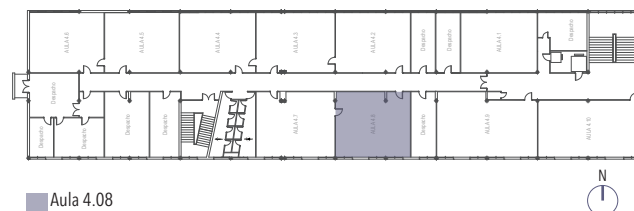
Plano de la planta cuarta de la ETSA - US. Fuente: [www.etsa.us.es/descargas/general/planos/ETSA](http://www.etsa.us.es/descargas/general/planos/ETSA). Figura editada por autor.
